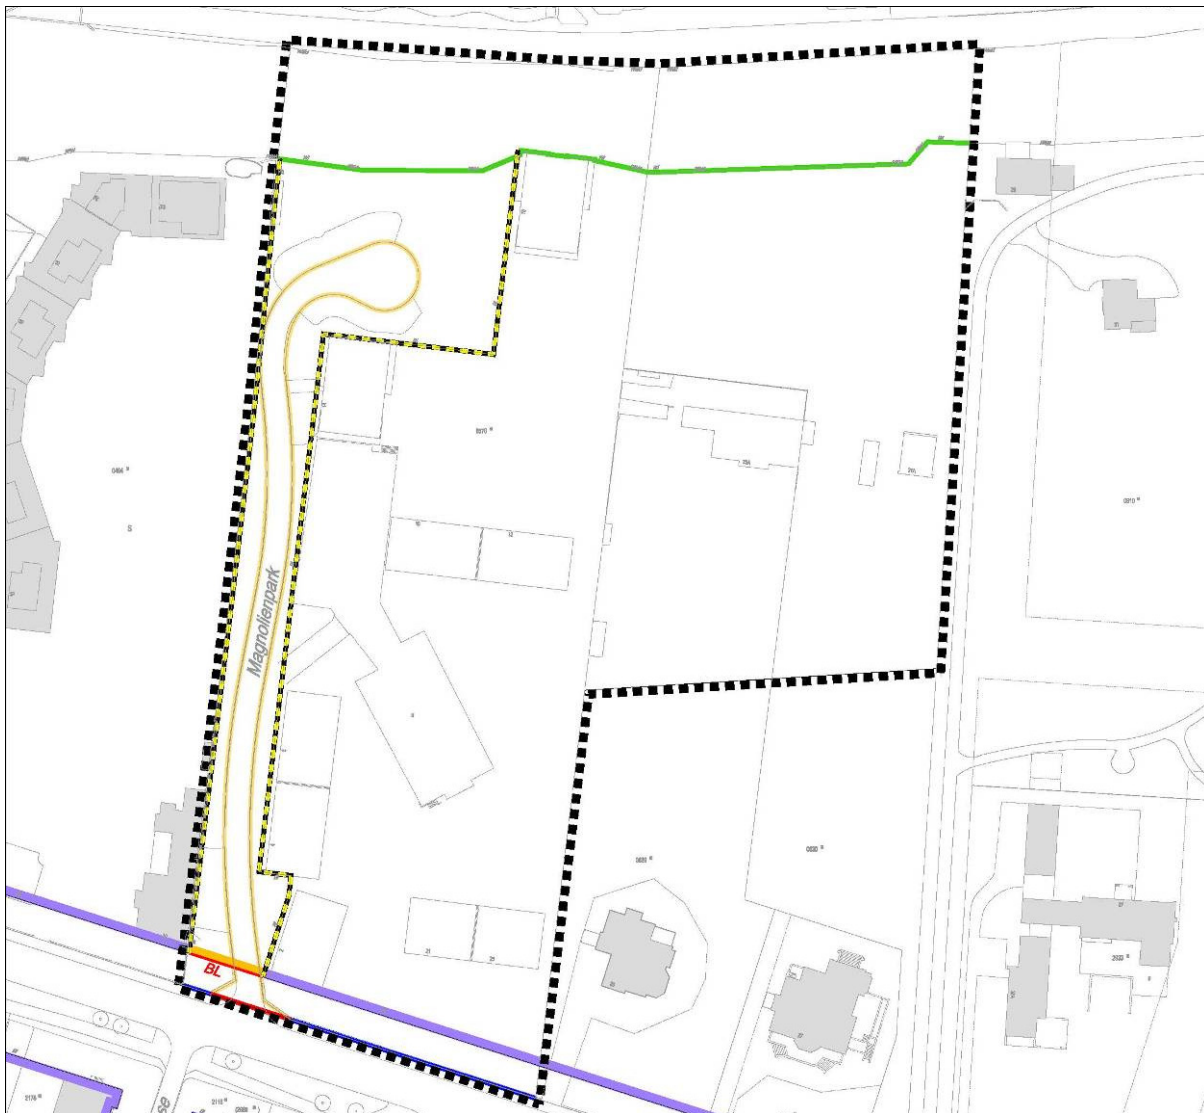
Neue Bau- und Strassenlinien. Plan Nr. 13'689 (Ohne Massstab, Plan genordet)
